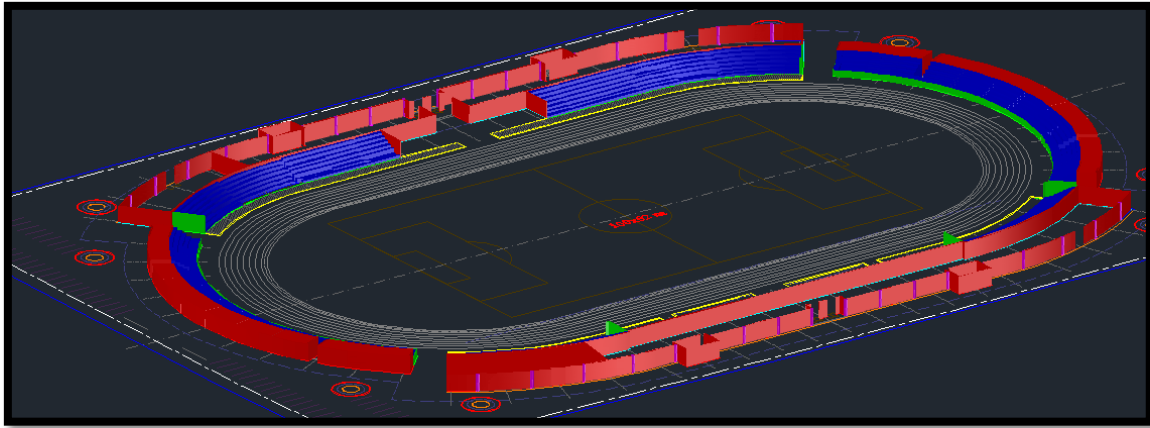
Paredes y Tribunas en 3D de la planta principal.
